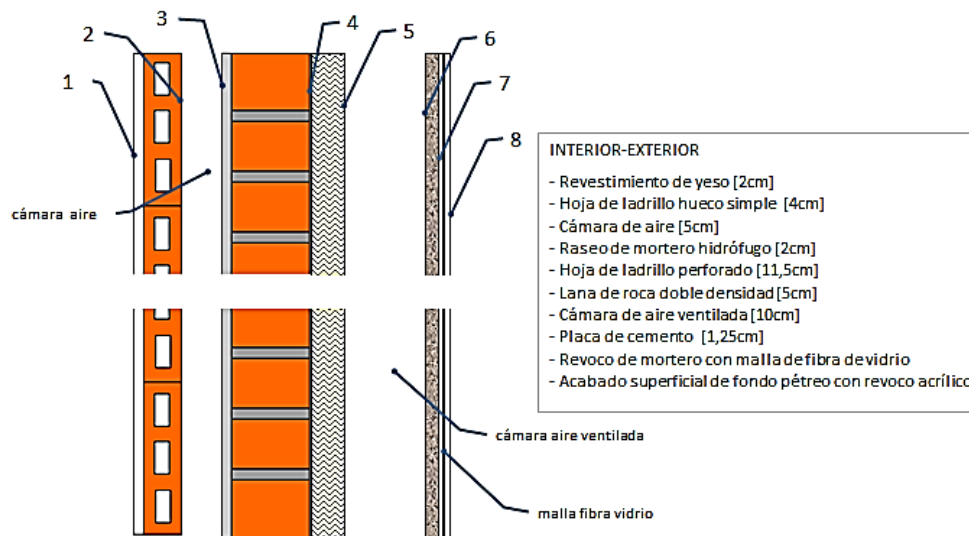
Solución constructiva de la fachada ventilada ligera
